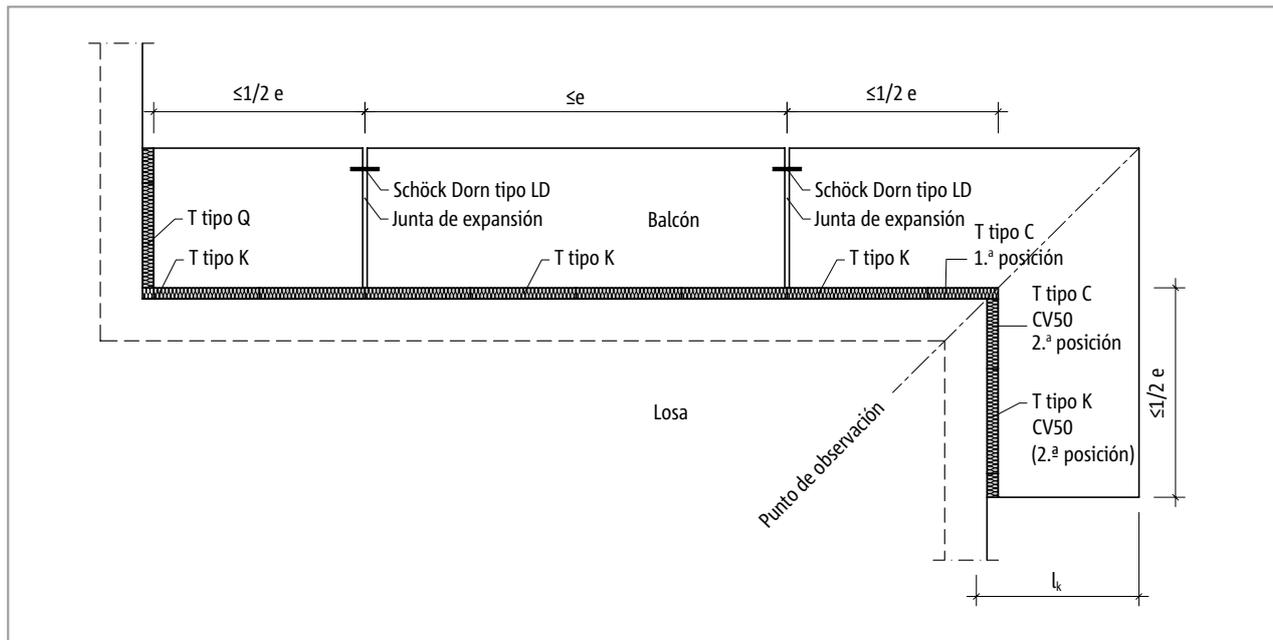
Schöck Isokorb® T tipo C: Disposición de las juntas de expansión
